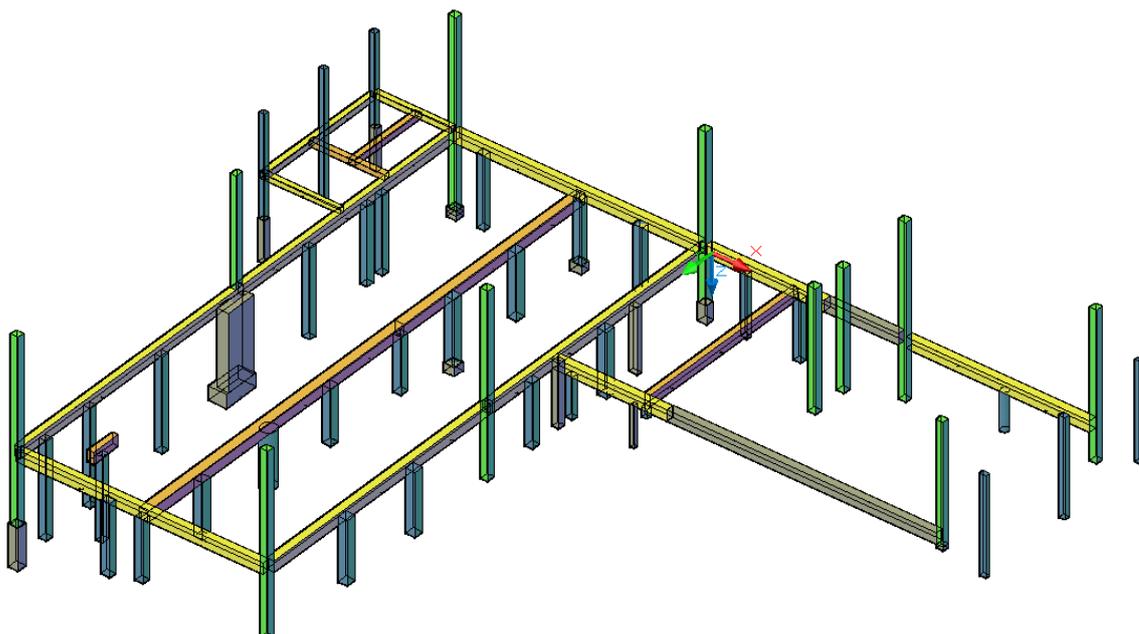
Representação 3D dos esteios estruturais em verde, dos pilares em azul, do baldrame em amarelo, do barroteamento primário em laranja e de algumas intervenções (concreto) em cinza.
